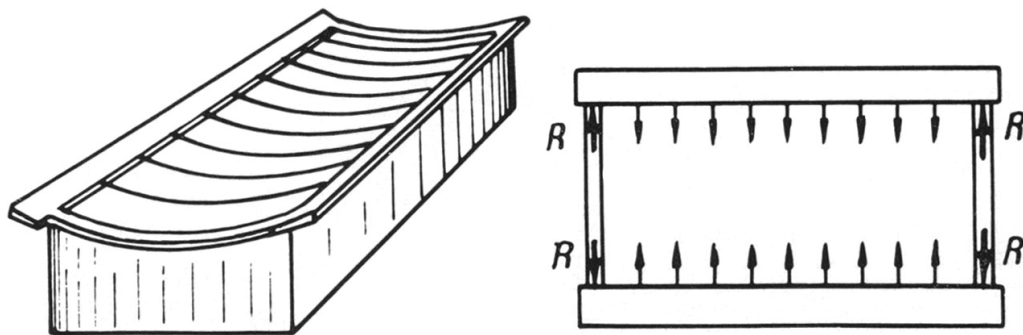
Kräfteverlauf bei geschlossenem Randverankerungssystem mit Rechteckgrundriss [Rabinovič 1966]
